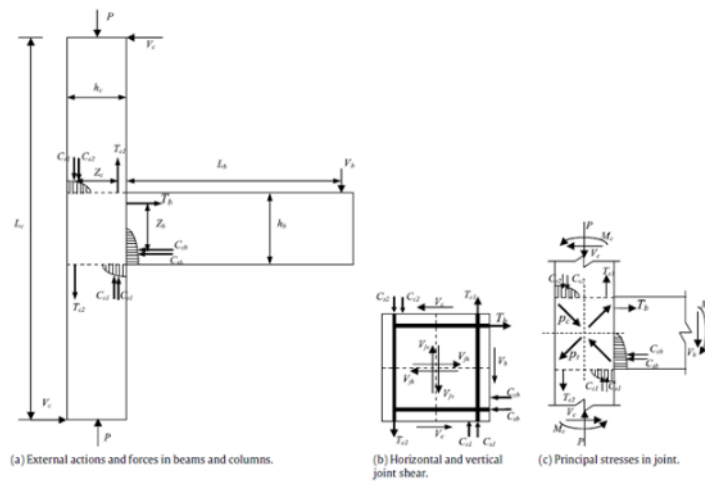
Fuerzas y esfuerzos en conexiones exteriores
